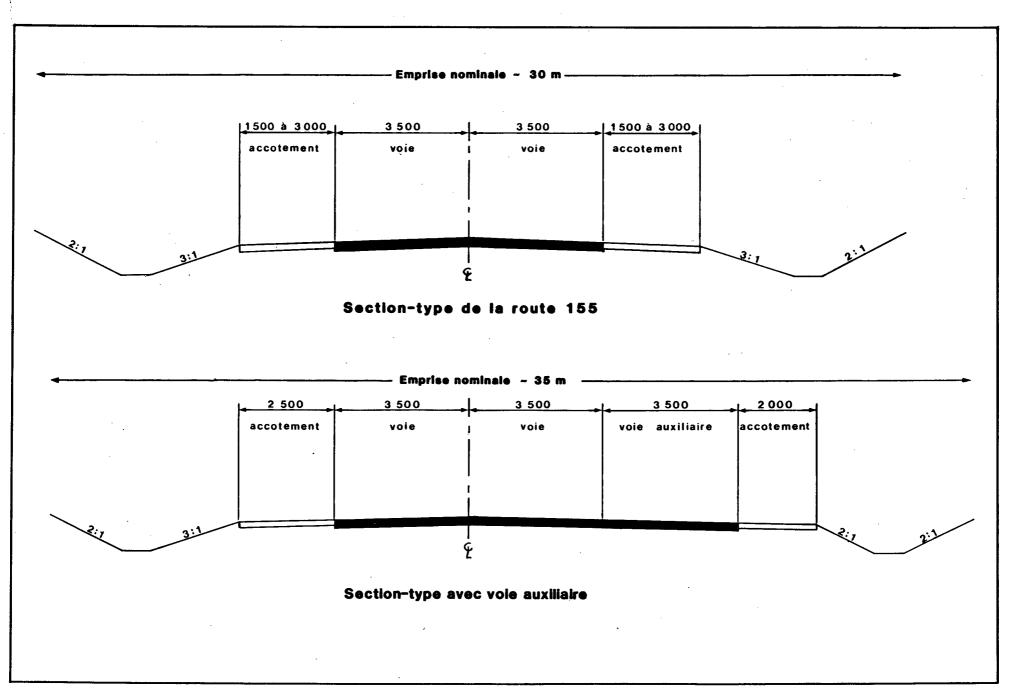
SECTION-TYPE DE LA ROUTE 155 & SECTION-TYPE AVEC VOIE AUXILIAIRE
